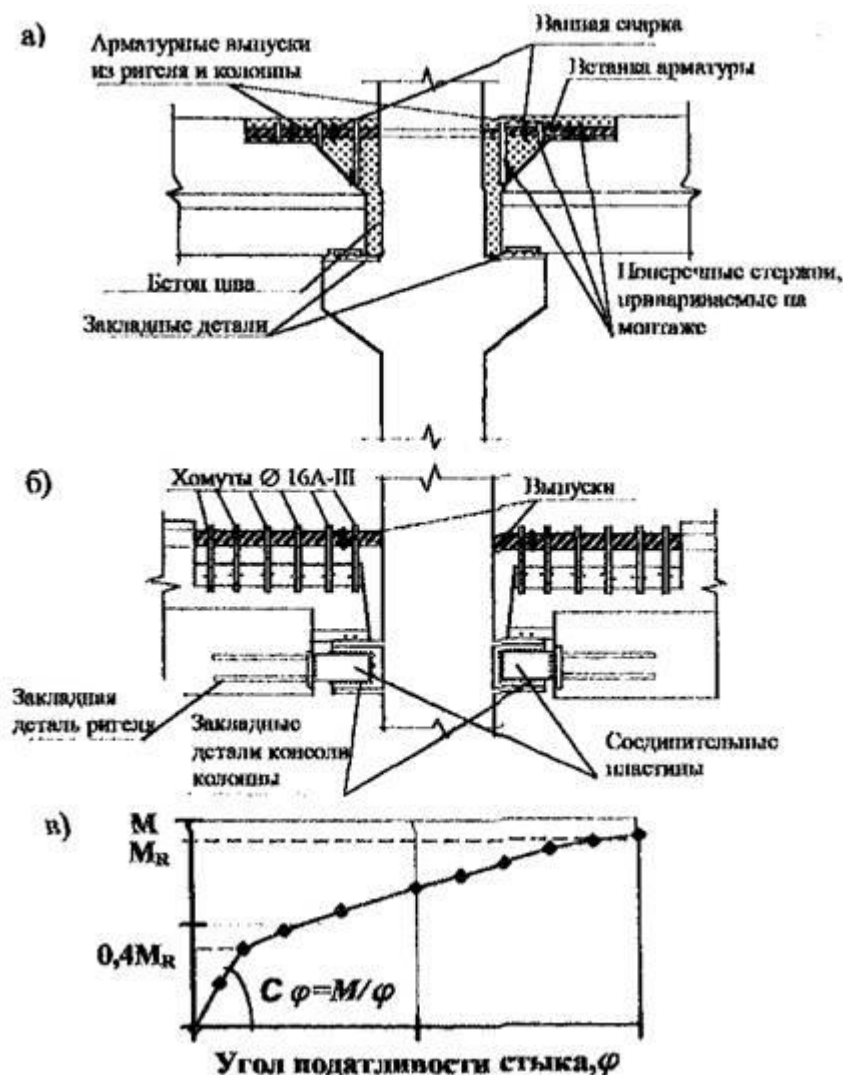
Рамный узел сопряжение ригеля с колонной: а) с опиранием на открытую консоль; б) с опиранием на скрытую консоль; в) график зависимости угла податливости сопряжения от изгибающего момента
